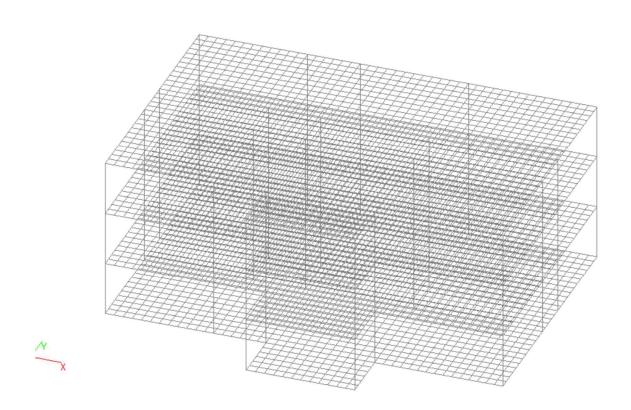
Геометрическая схема междуэтажного перекрытия
